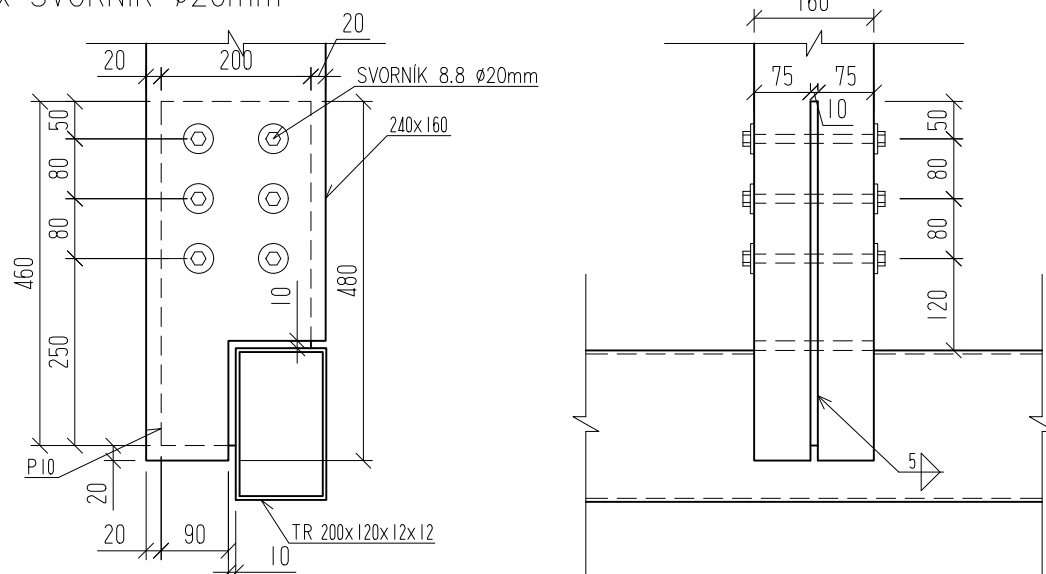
DETAIL E – NAPOJENÍ NÁROŽNÍKU
